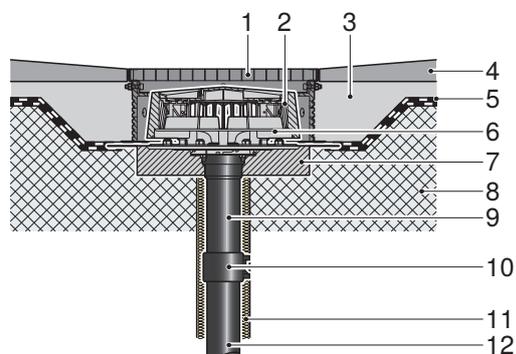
Монтаж на неизолированной жесткой кровле с битумным кровельным покрытием, подходящим для передвижения транспортных средств
